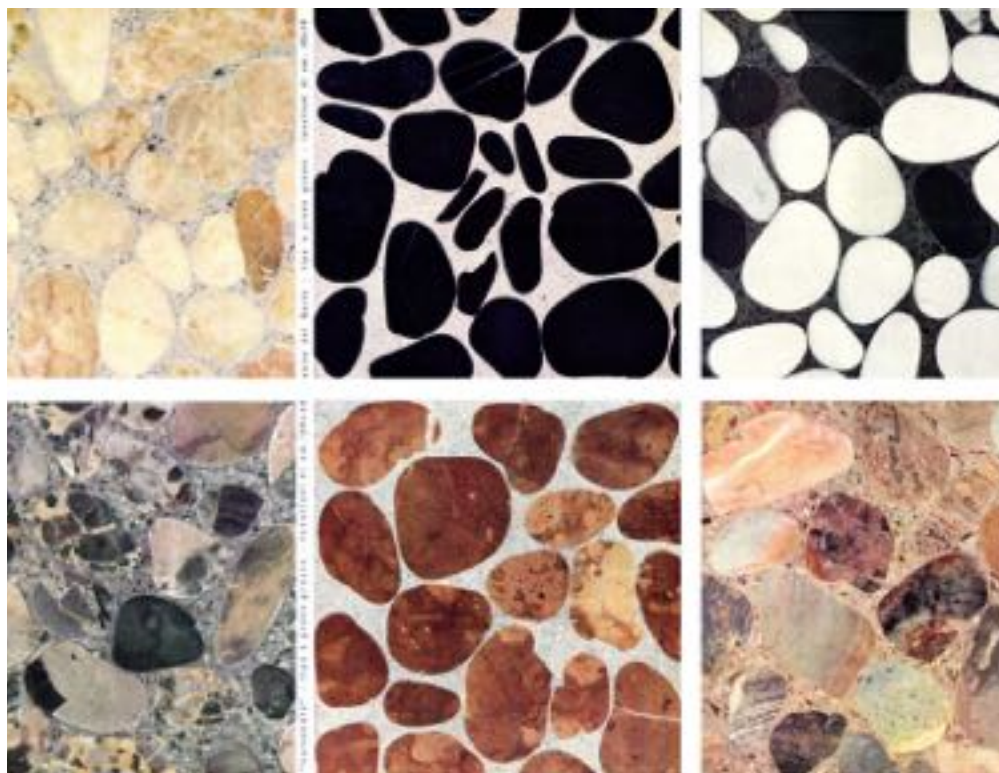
| Tipologie di elementi modulari per pavimenti in marmi ricomposti, brevetto Fulget.
